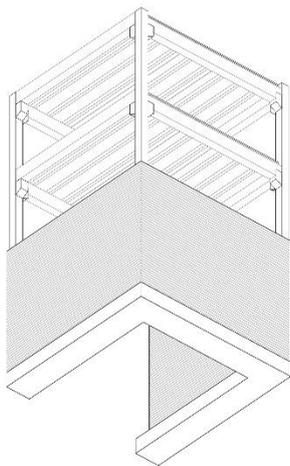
Axorometría Estructural - Techo, Planta Baja y Primera - Alzado Sur
